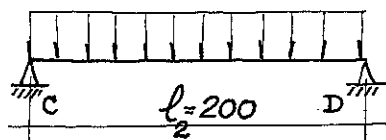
Viga Simplesmente Apoiada - Terça
